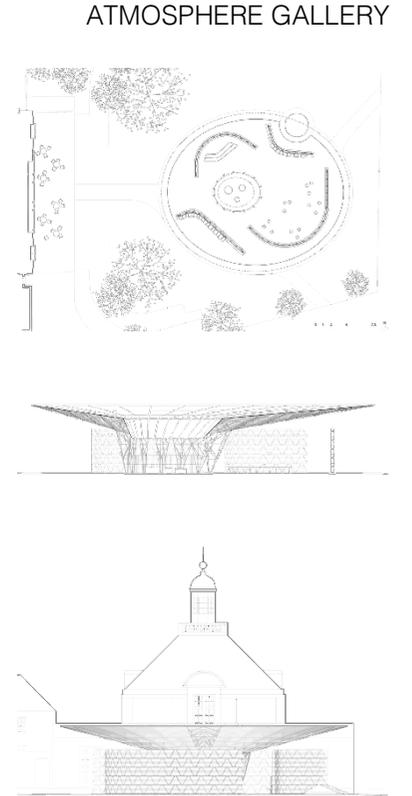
(1ª) Planta del pabellón. (2ª) Sección longitudinal. (3ª) Alzado en relación con la galería.
